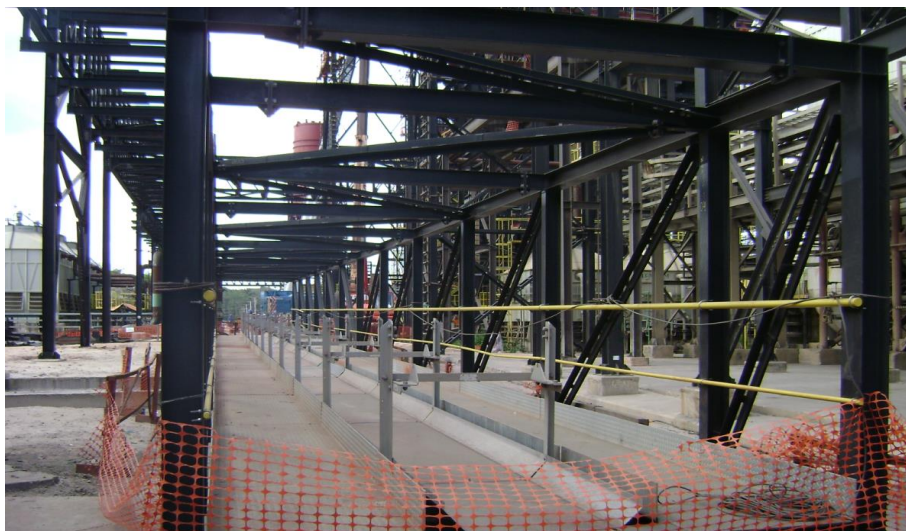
Galeria de Aço em Montagem - Detalhes dos Elementos Não Estruturais (fonte TMSA/2006)
